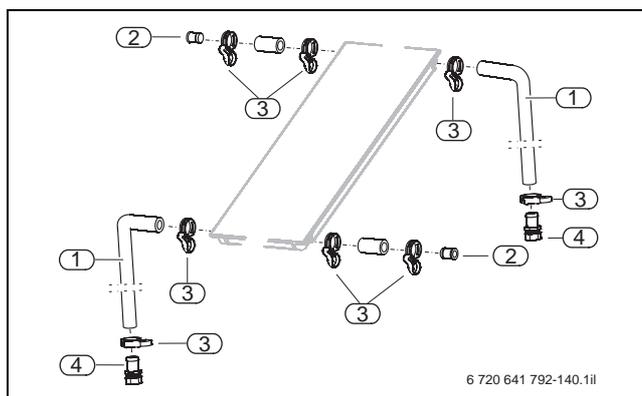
Set di collegamento Logasol SKN4.0 sopra tetto
